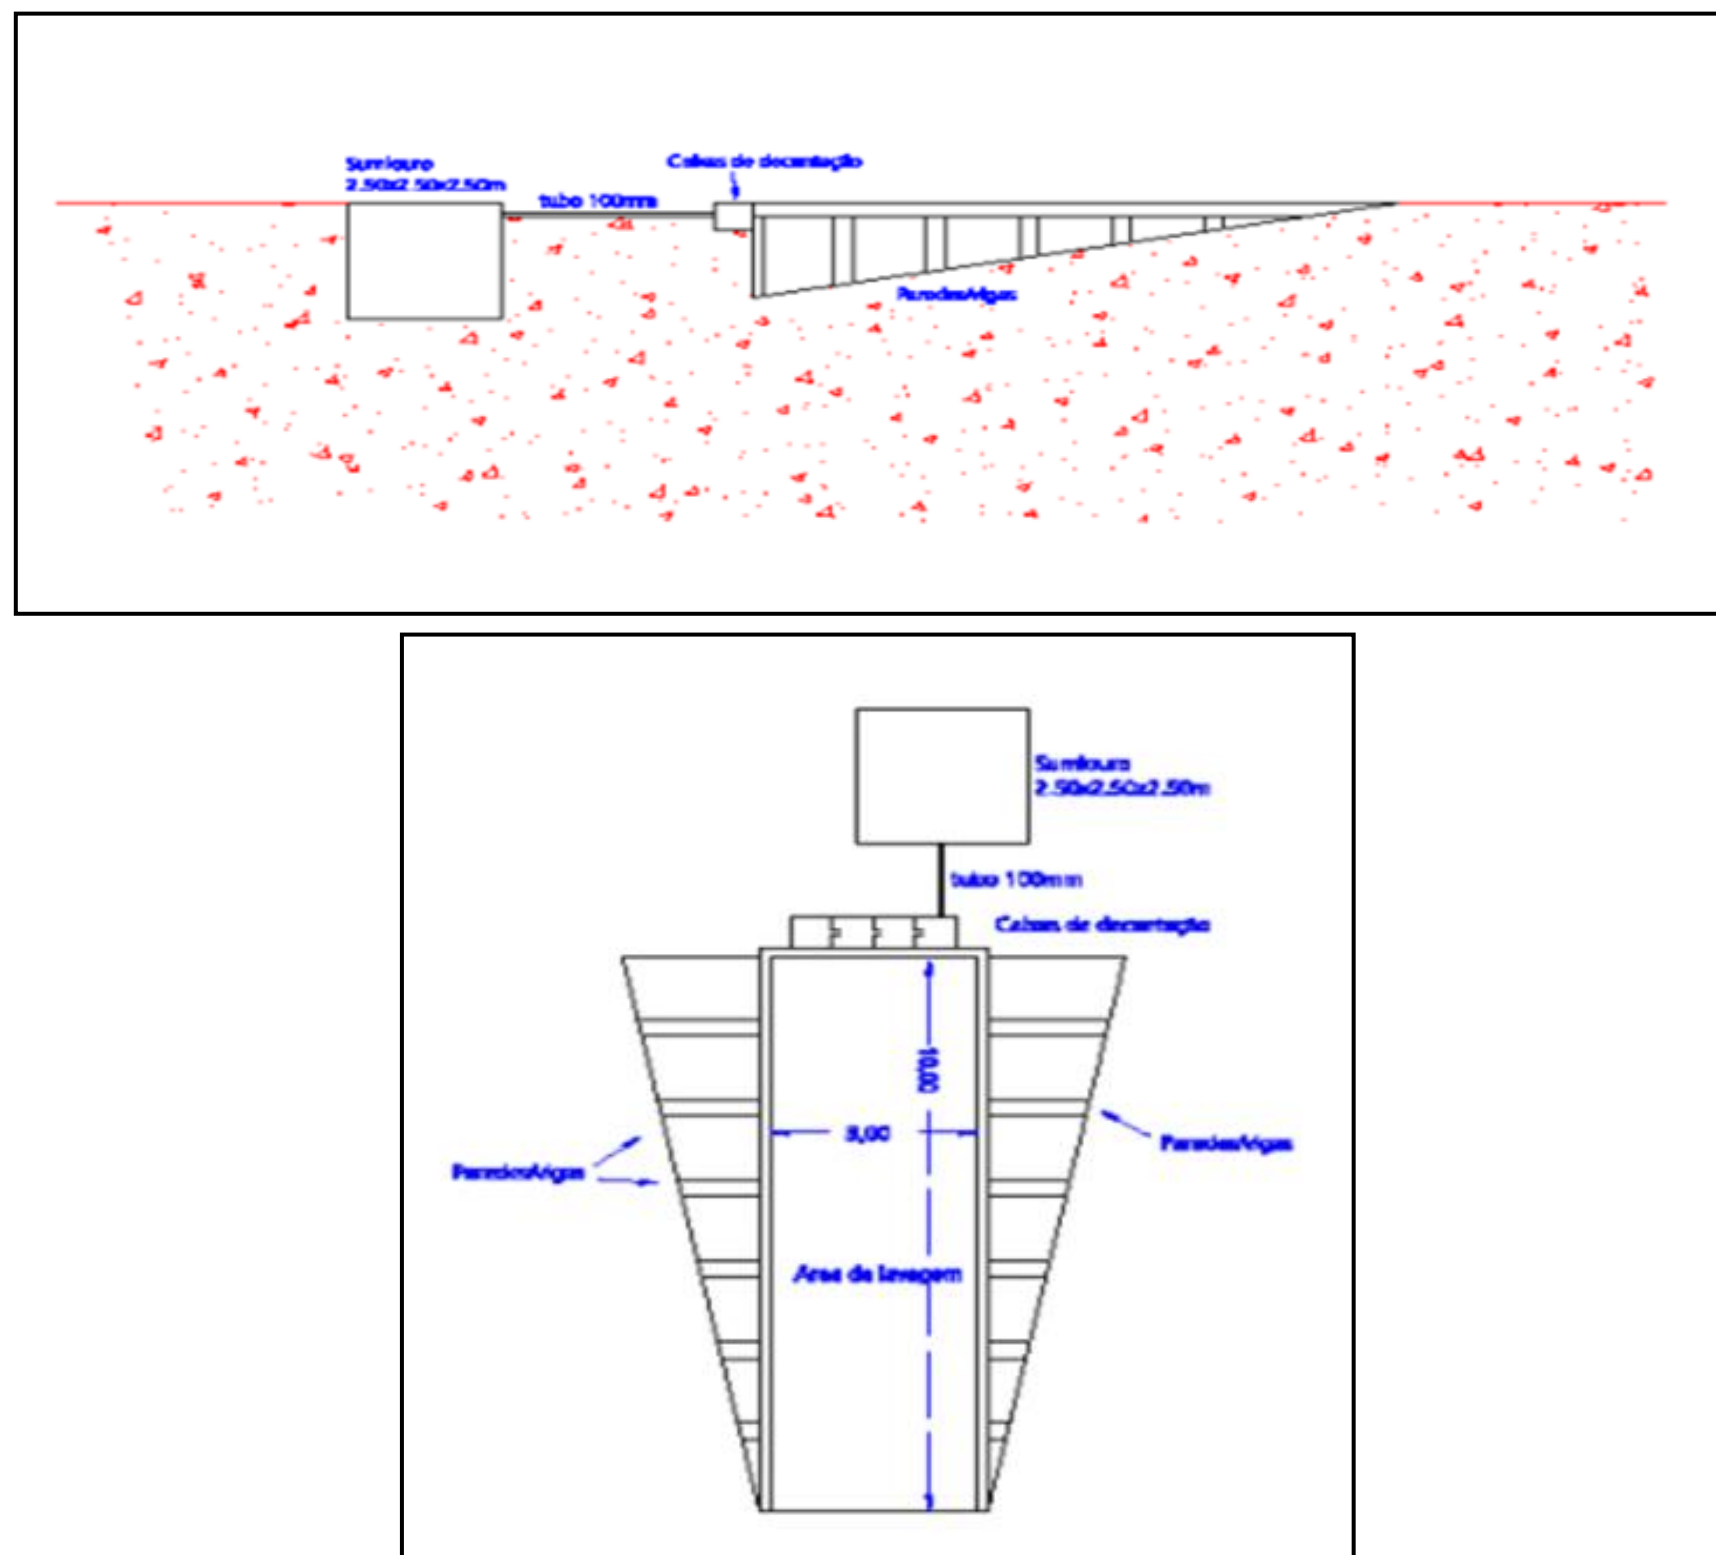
Desenho esquemático de um Sistema de Tanque Bate - Lastro para decantação do lodo de concreto. Fonte: Procedimento para Gerenciamento de Resíduos Sólidos LVTE/2012.
